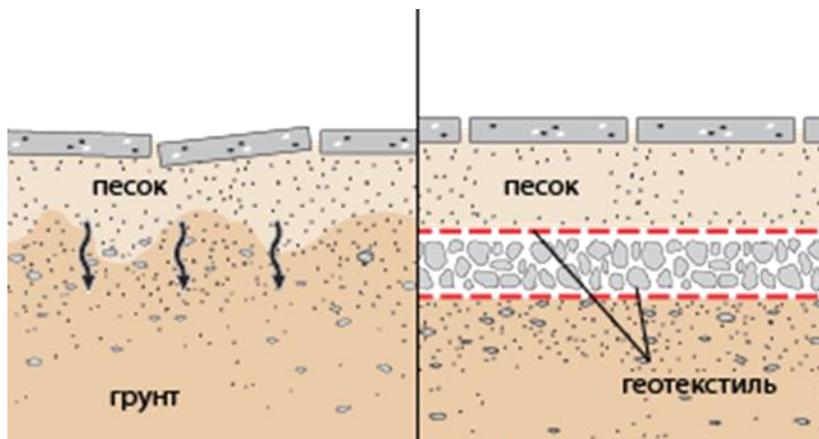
Сравнение работы грунта без армирования и с армированием геотекстилем
